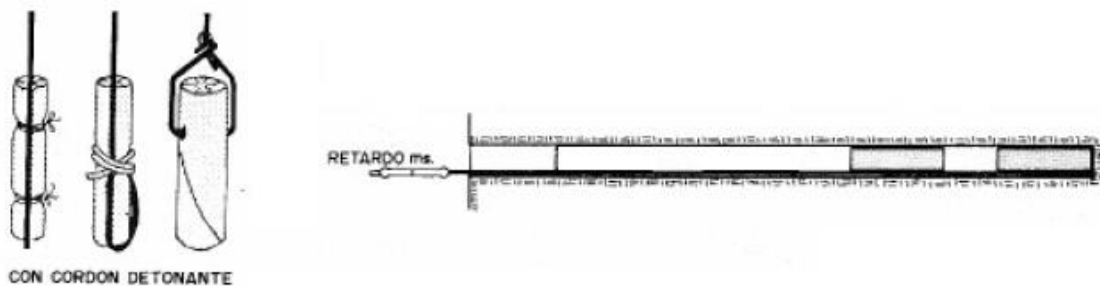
Cebado con cordón detonante <sup>(6)</sup>
